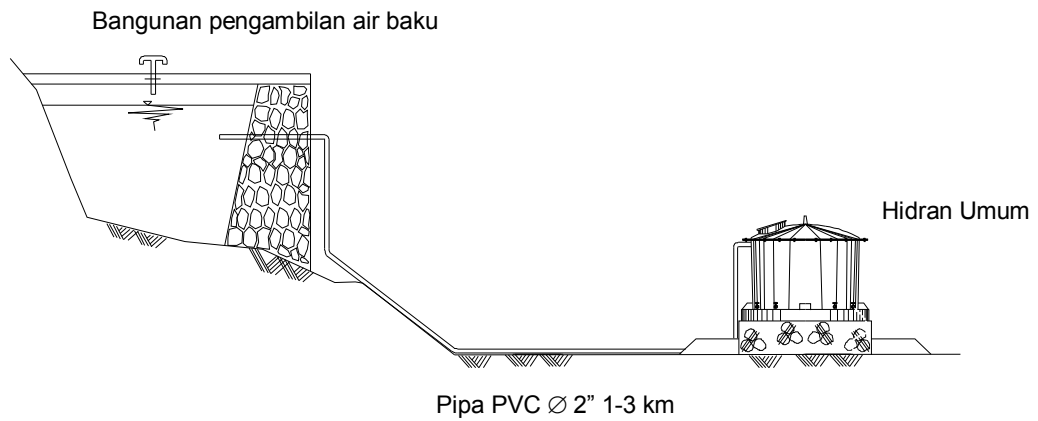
Potongan 1 bangunan pengambilan sumuran
